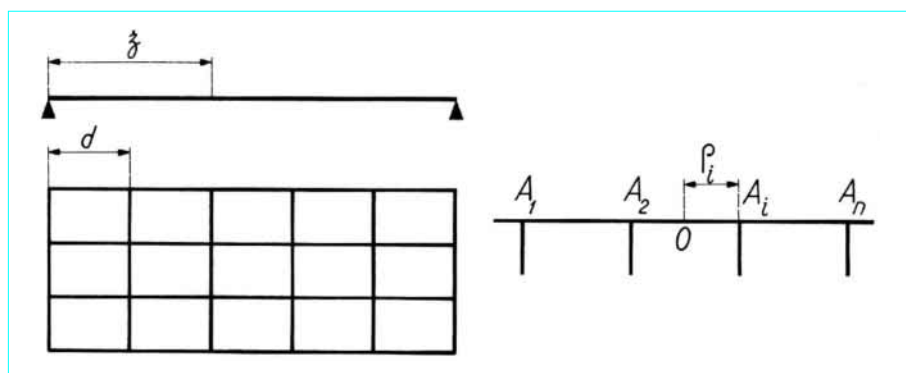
Travée à poutres multiples solidarisiées par des entretoises
